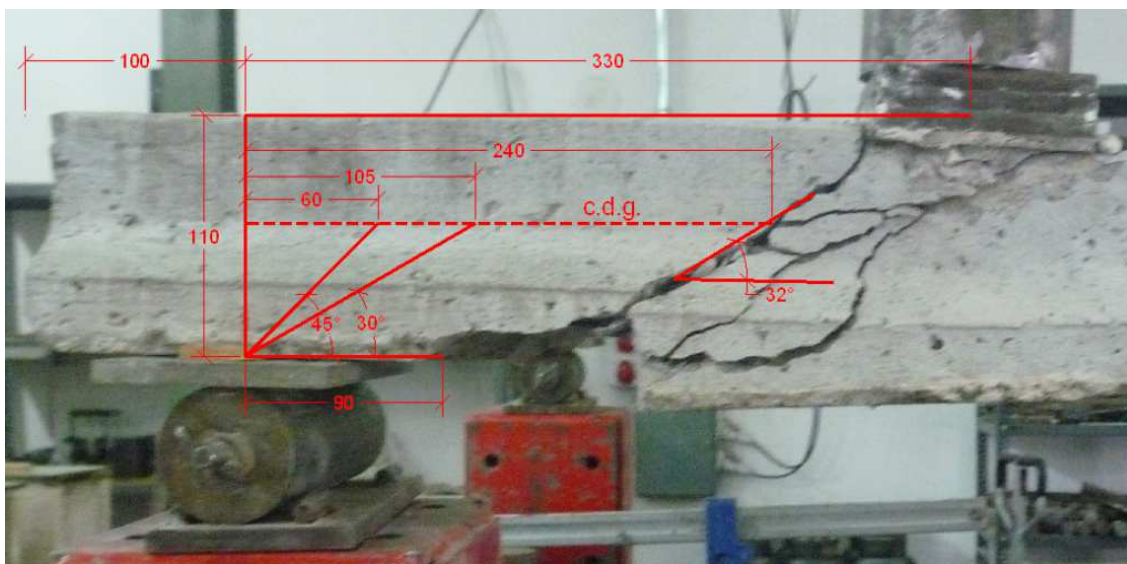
a. Rotura por cortante en vigueta aislada VP02 (T-11-2) All-pg.593
